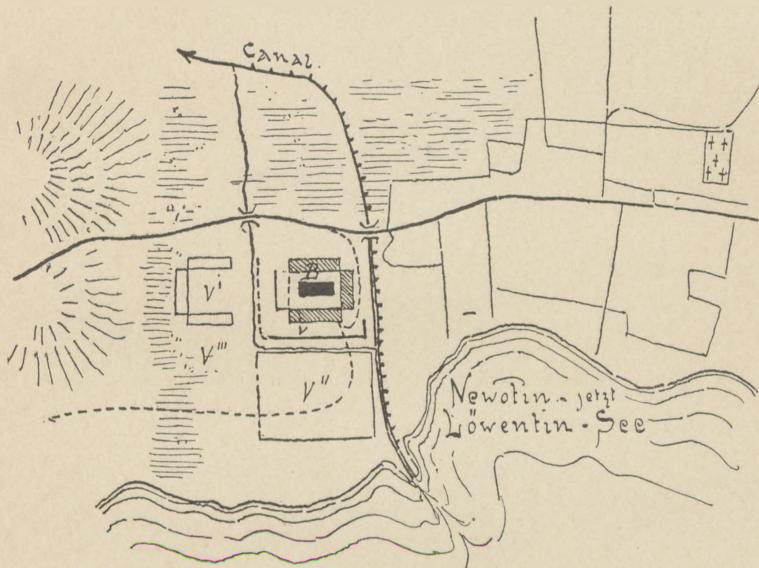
Lageplan des Hauses Lözen nach Giese.
